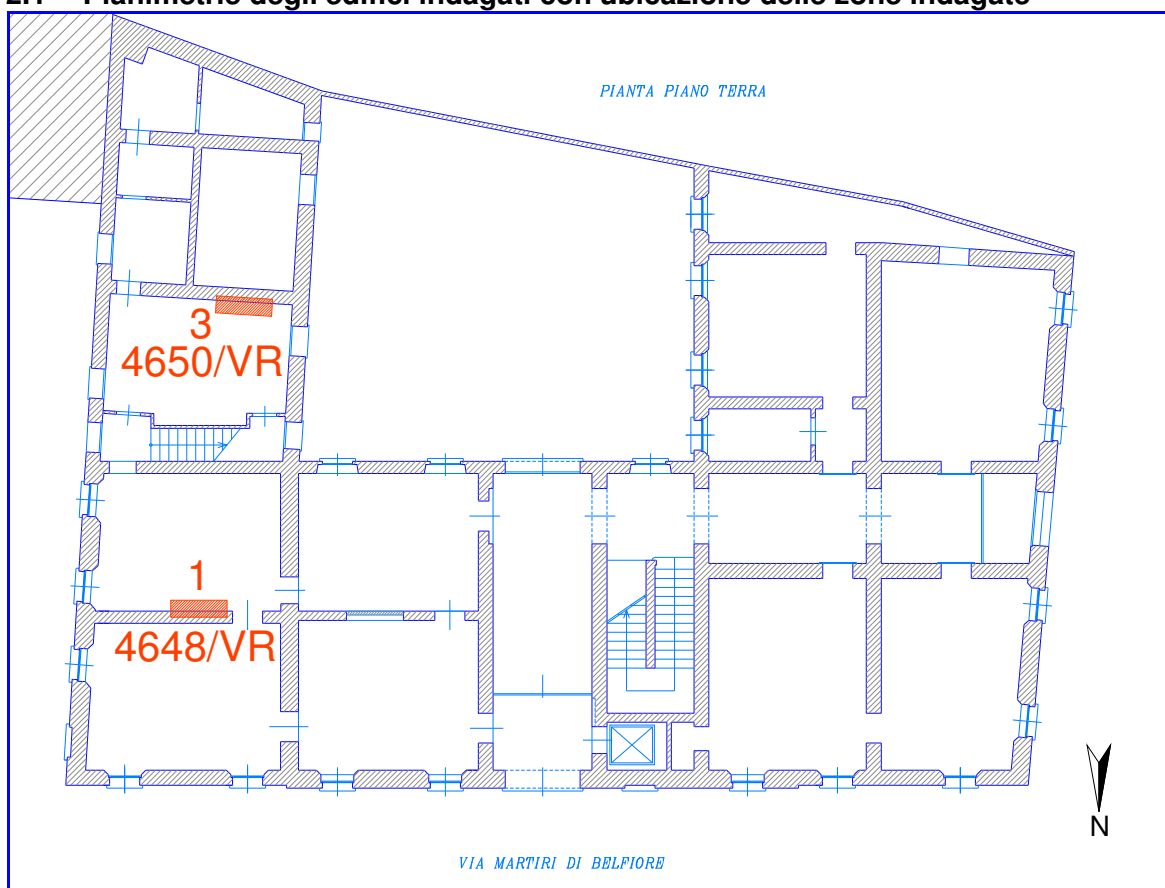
Planimetria del piano terra con ubicazione delle zone indagate
